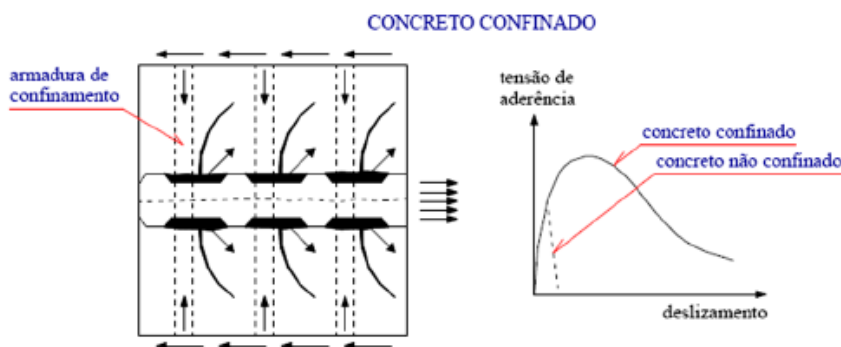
Fendilhamento do concreto - FUSCO (1995)
